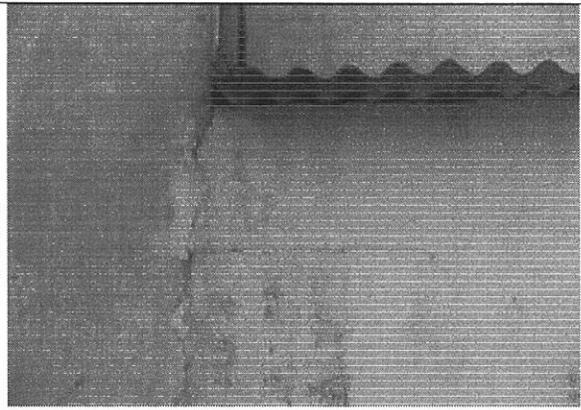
Fisuras en la parte superior del muro del costado occidental
